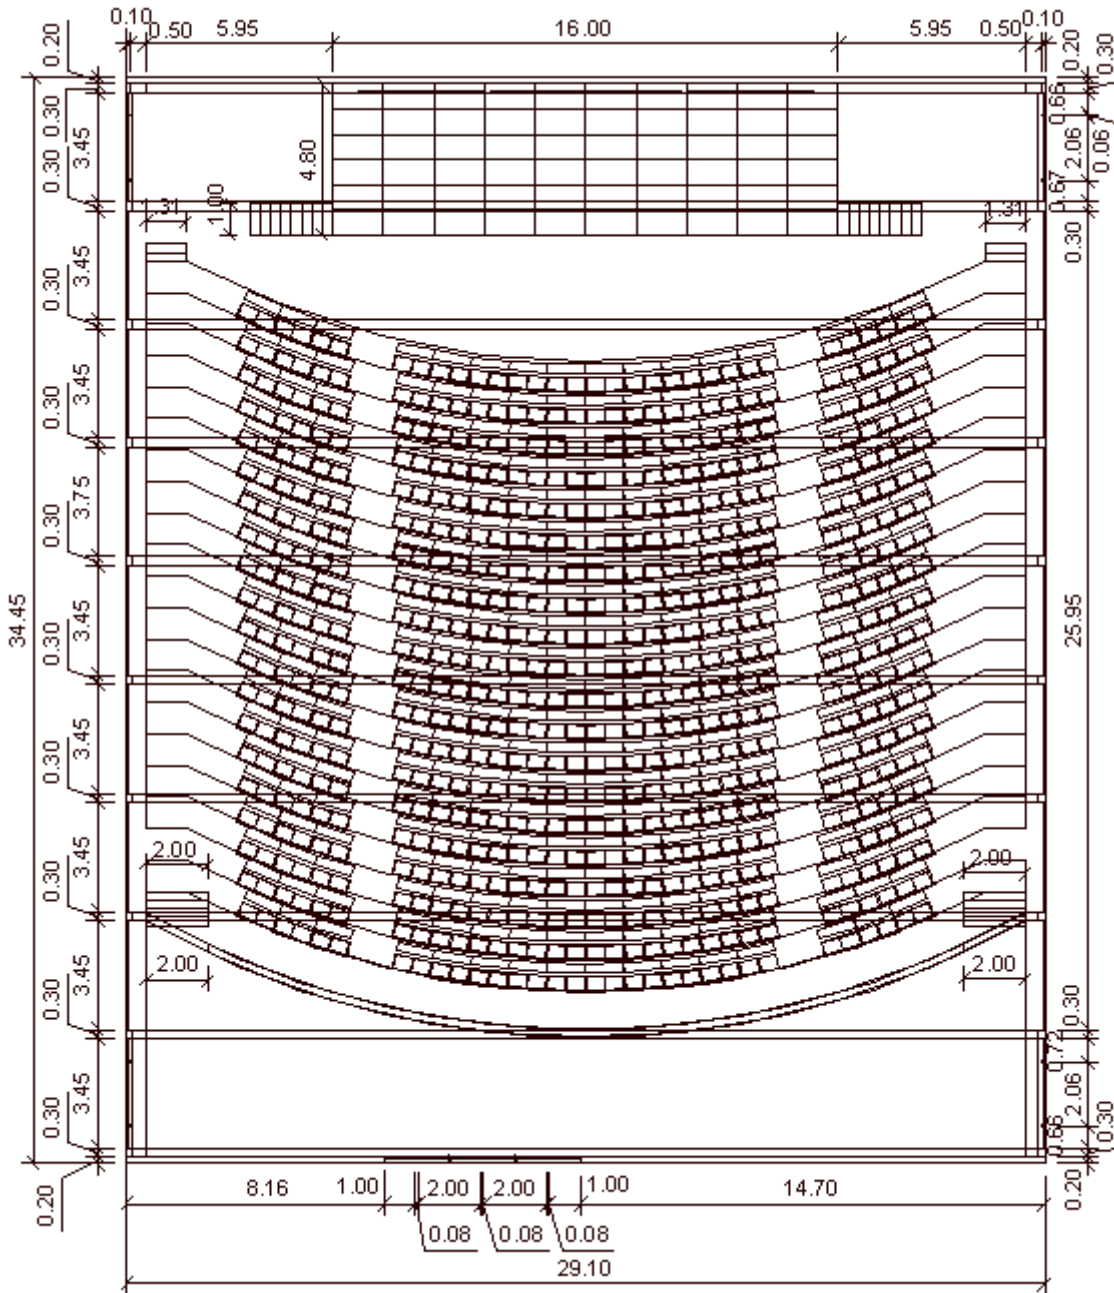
Grundriss des Hörsaalgebäudes
